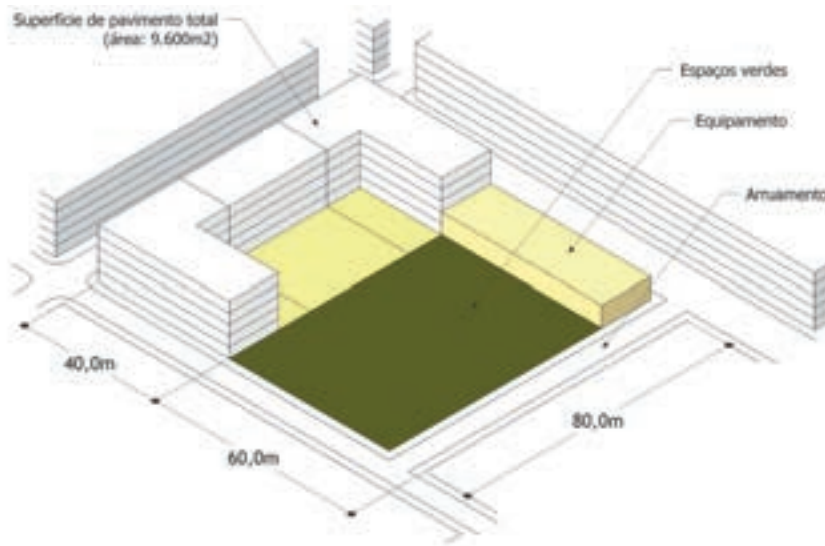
Implantação dos edifícios na área líquida do loteamento
